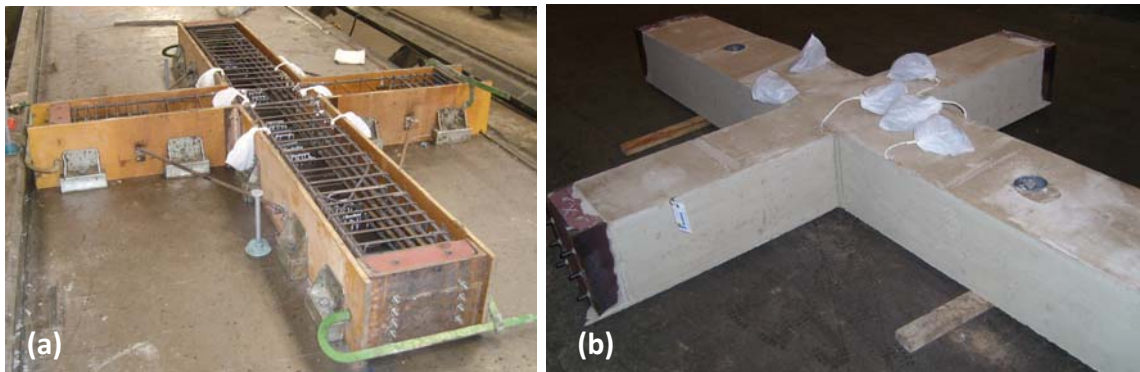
Fabricación de la probeta de hormigón armado. a) ferralla de la probeta colocada en el encofrado para su hormigonado, b) probeta finalizada con la instrumentación protegida en bolsas.
